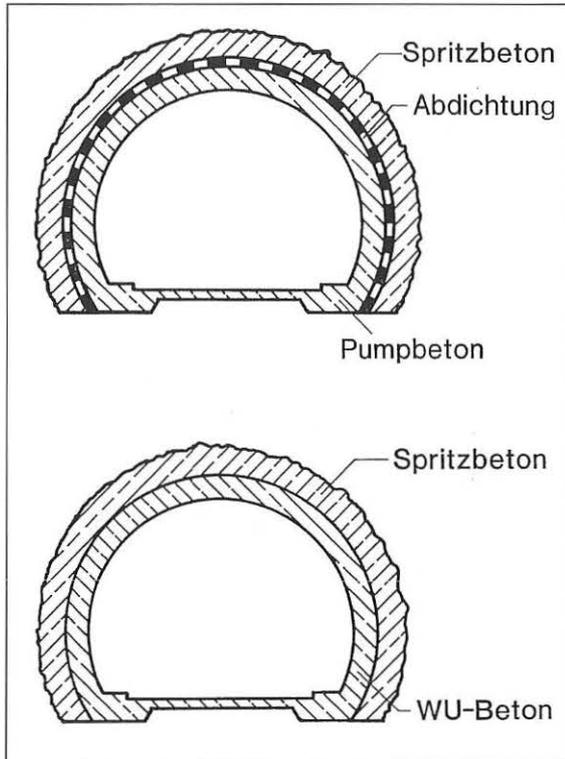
Zweischalige Tunnelbauweise mit Hautabdichtung bzw. mit WU-Beton
